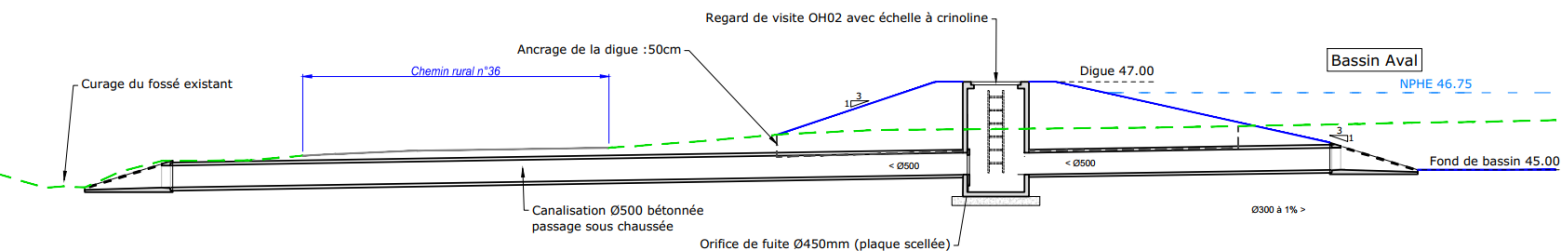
Coupe de l'ouvrage de fuite en aval (OH02)
